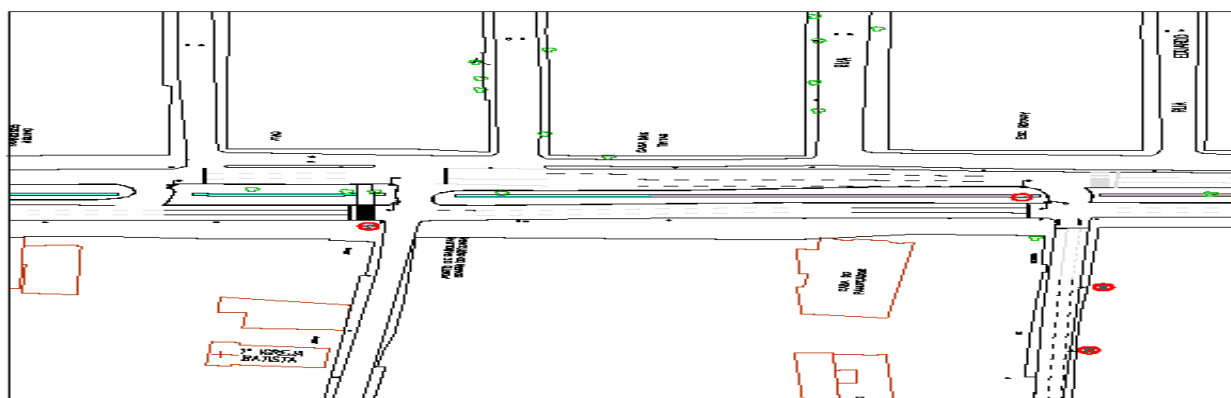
planta baixa do projeto – trecho Bomba da Marieta – Situação Anterior.
